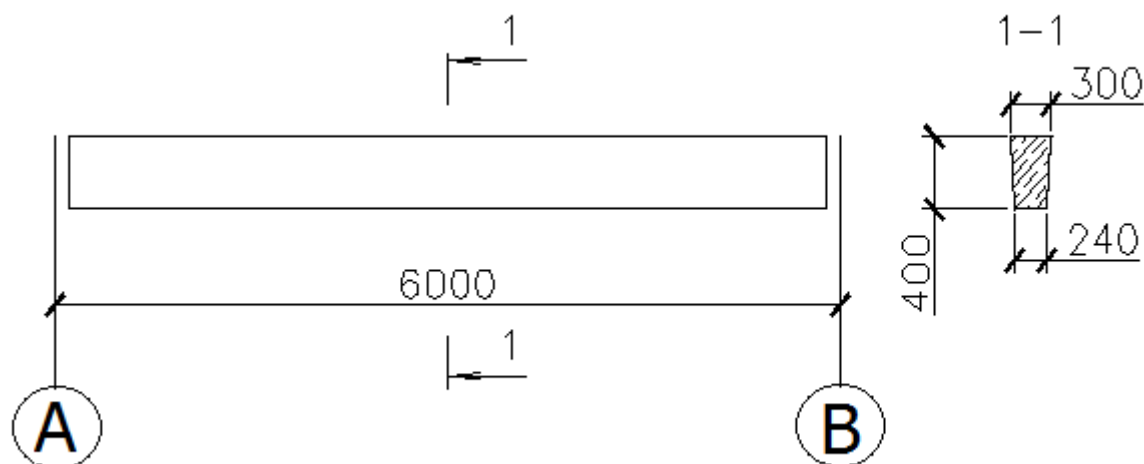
Фундаментная балка для шага колонн 6 м.
